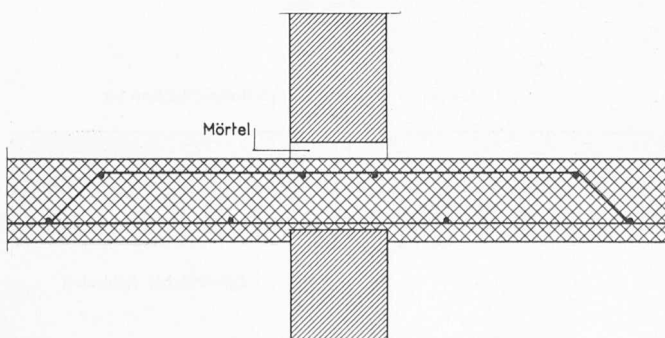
System Balency, Vertikalschnitt durch Fuge zwischen traditioneller Decke und Mauer
